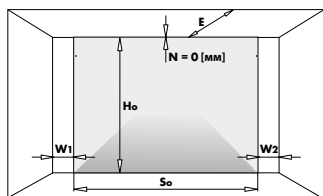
Монтажные размеры, необходимые для правильного выбора и установки подвесных откатных ворот – монтаж к потолку.
